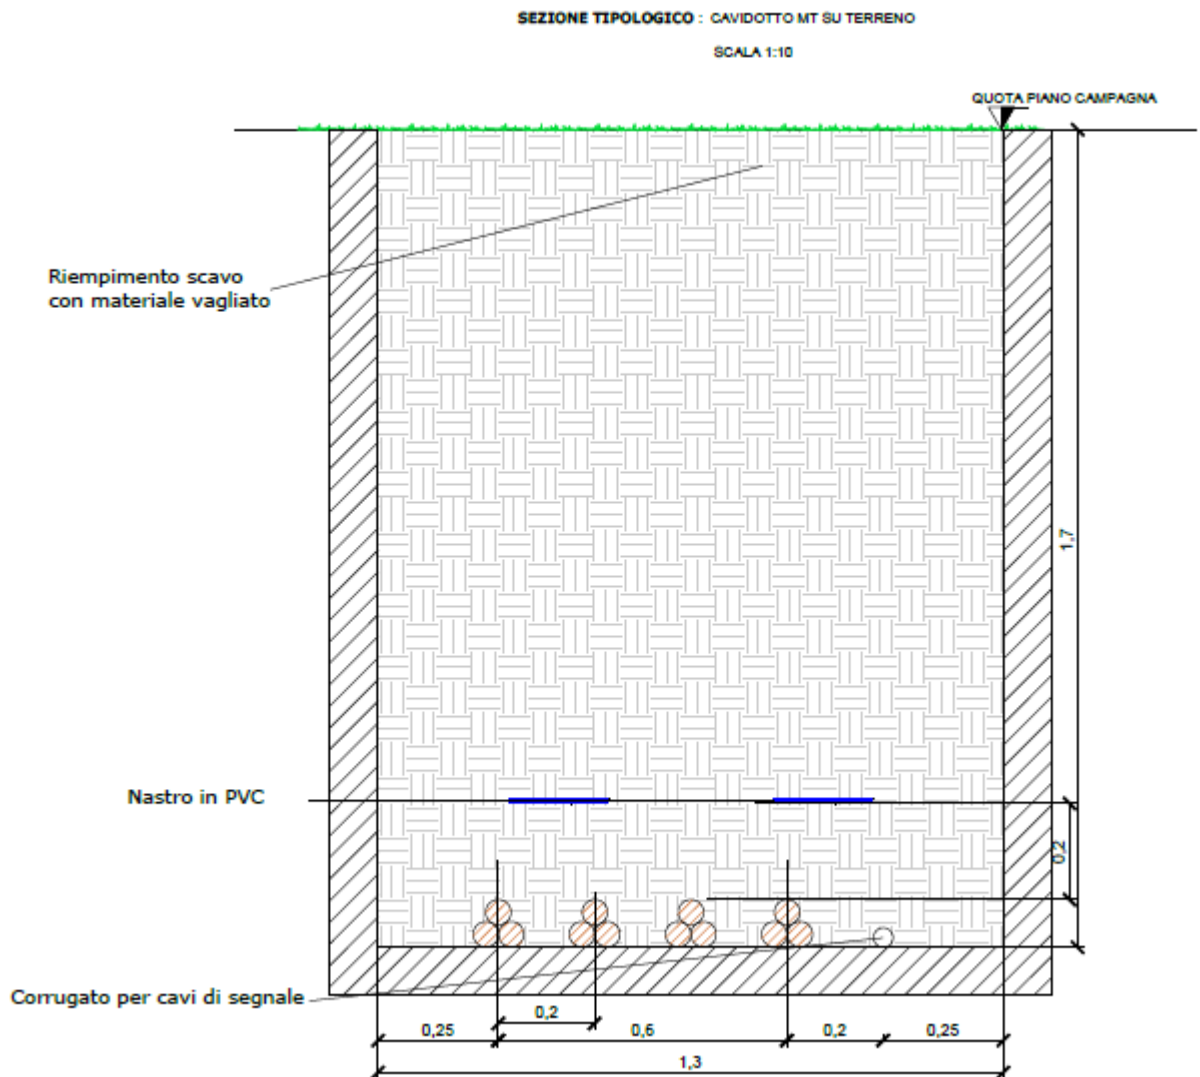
Sezione tipo posa con cavi direttamente interrati lungo terreno
